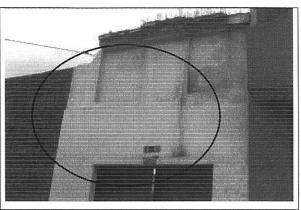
Fisuras y desprendimientos de unidades de mampostería
